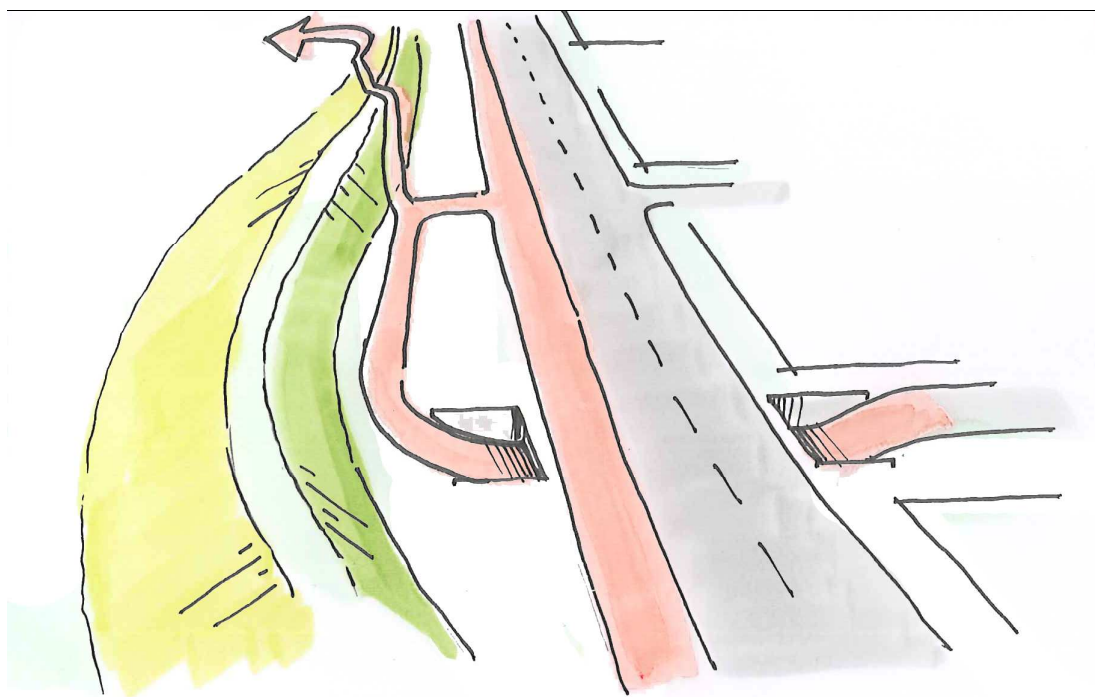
Principeschets van alternatief 1; groene dijk, fietstunnel handhaven.
